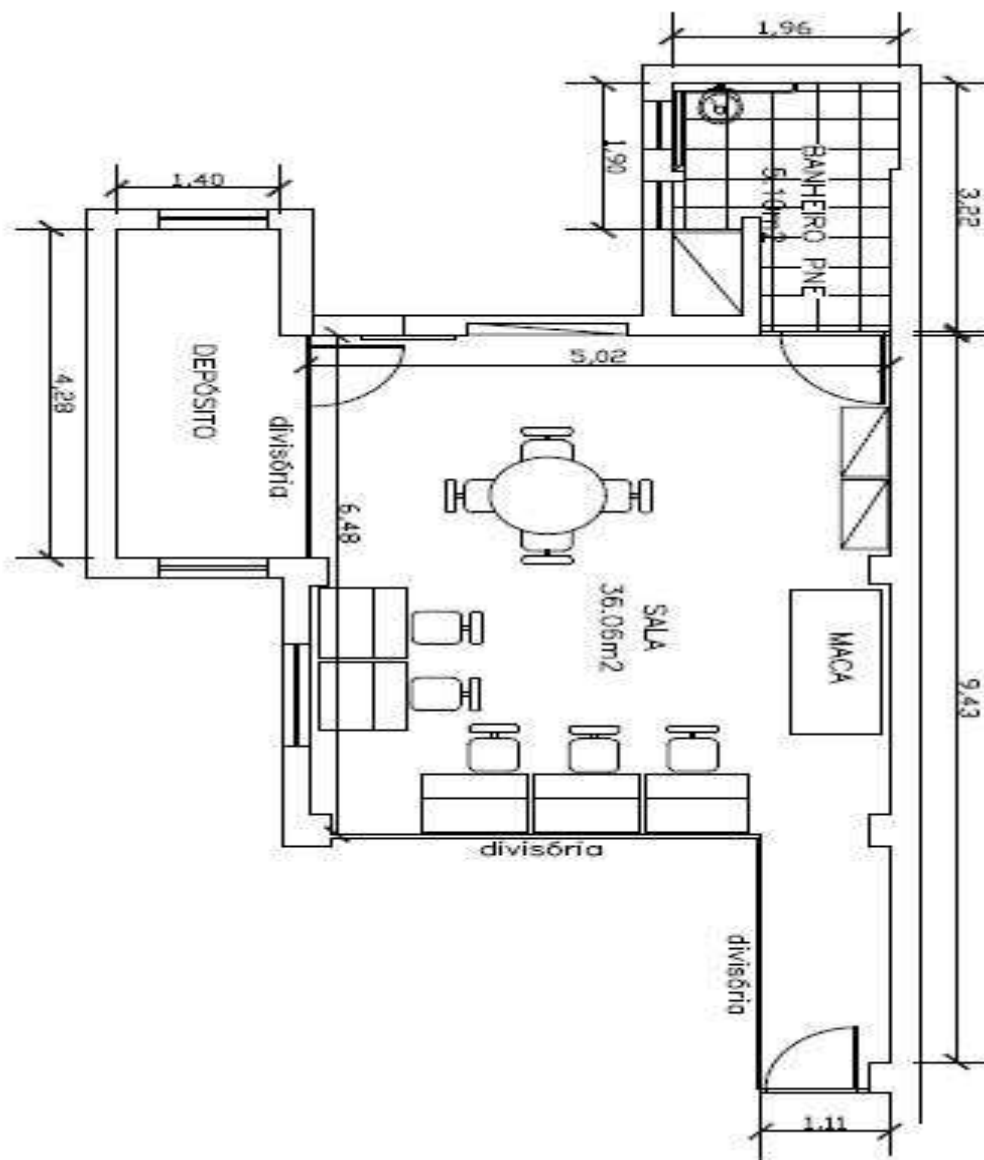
Elaboração da Planta Baixa do EIDE:
